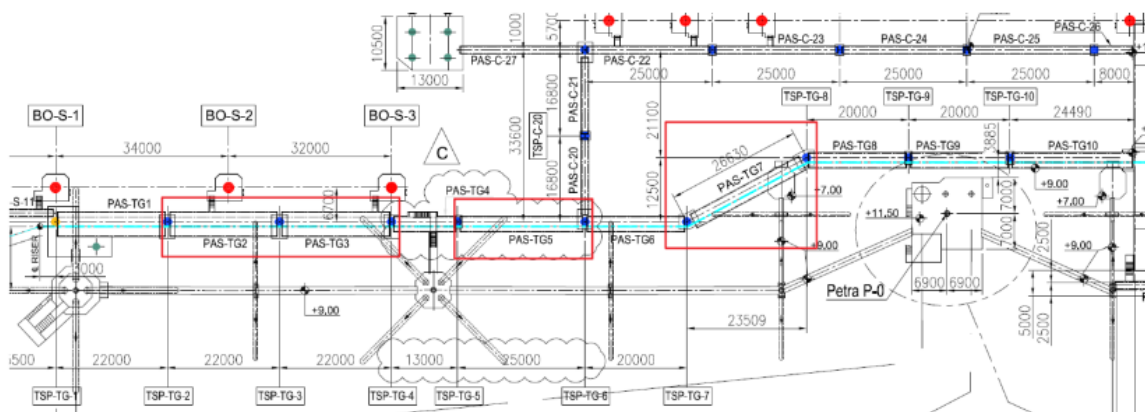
Planimetria Passerelle di Supporto della Tubazione Gas da 26"
